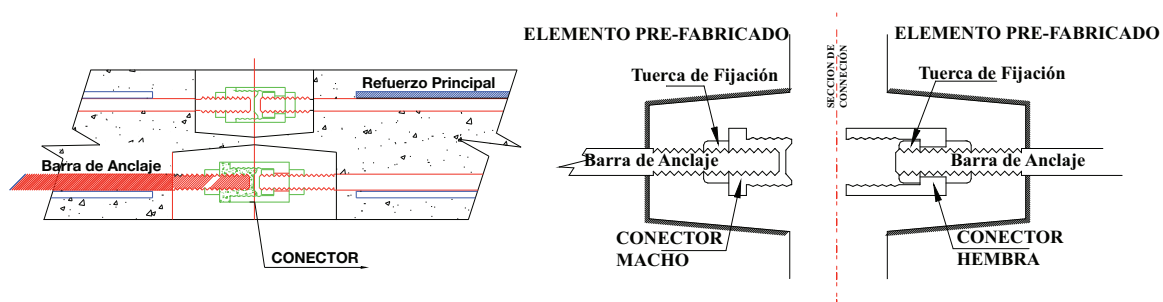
Vigas Pre-fabricada tipo: Detalle del Conector.
